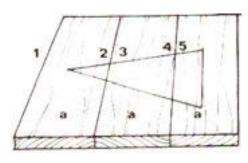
Cara membuat sambungan konstruksi papan tengah
